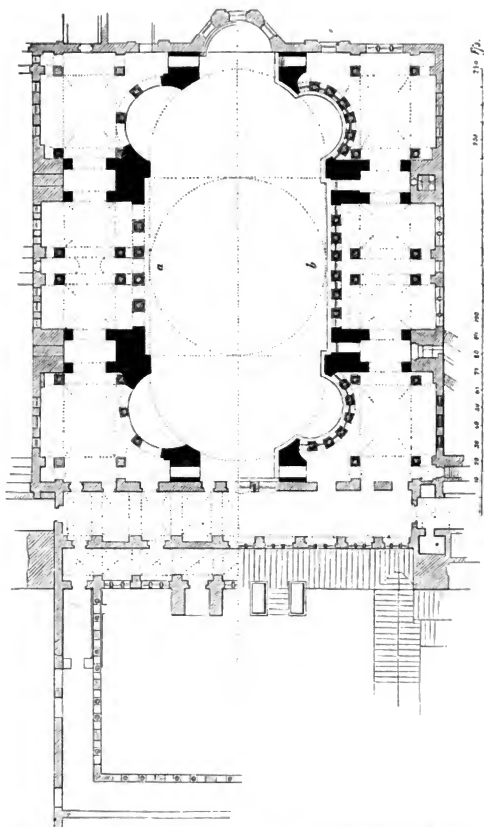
Sophienkirche in Constantinopel. Grundriss. (a Erdgeschoss, b Emporen.)
